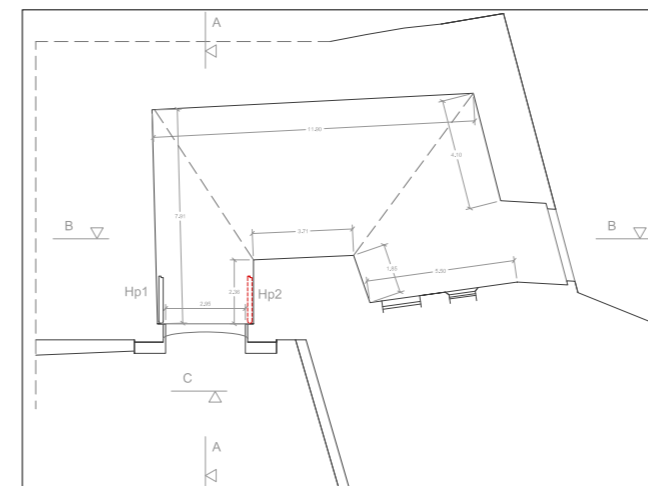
Planta del interior del portal. Proyecto de restauración. (Balaguer 2010).
